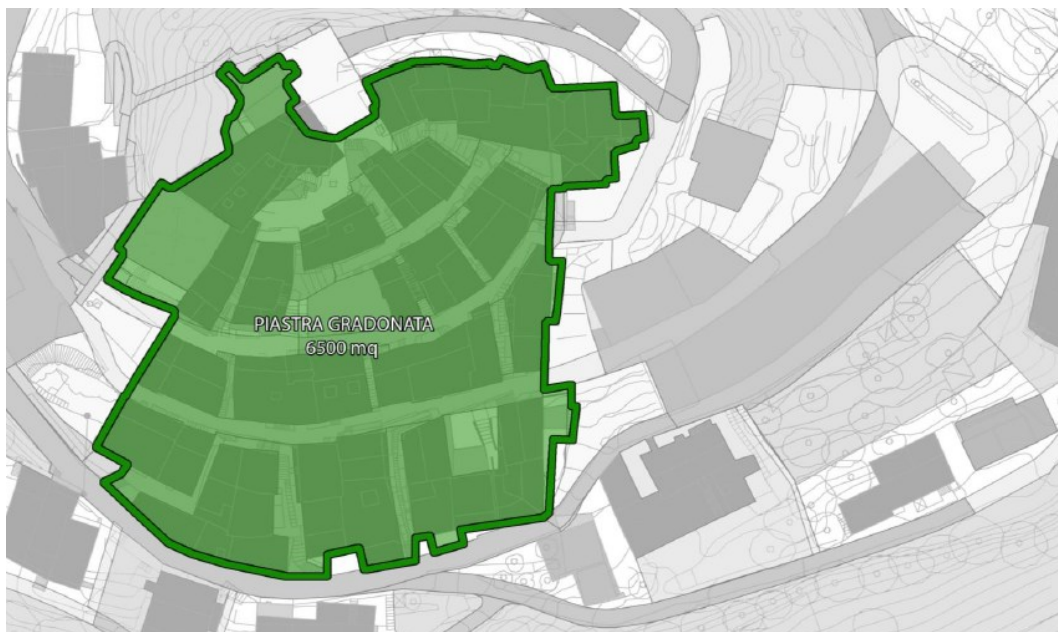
Individuazione planimetrica dell'area d'intervento
